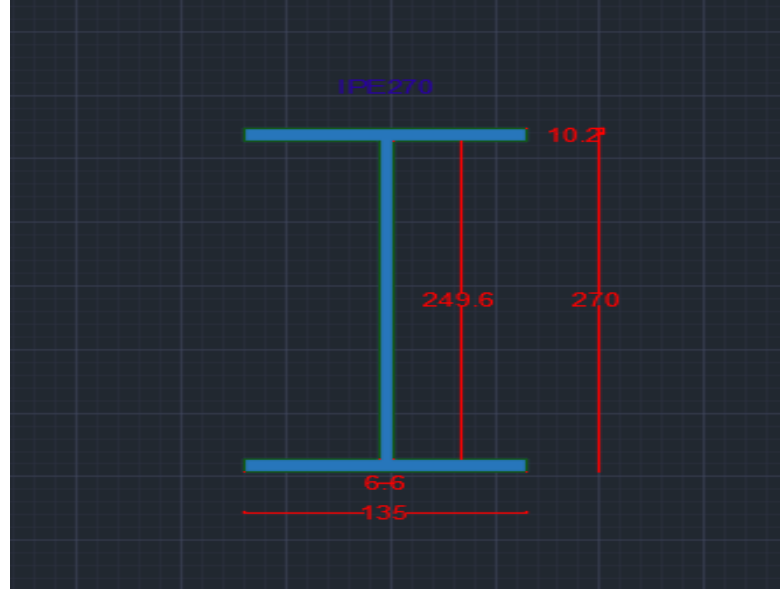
Çelik kolon elemanın profil geometrisi
